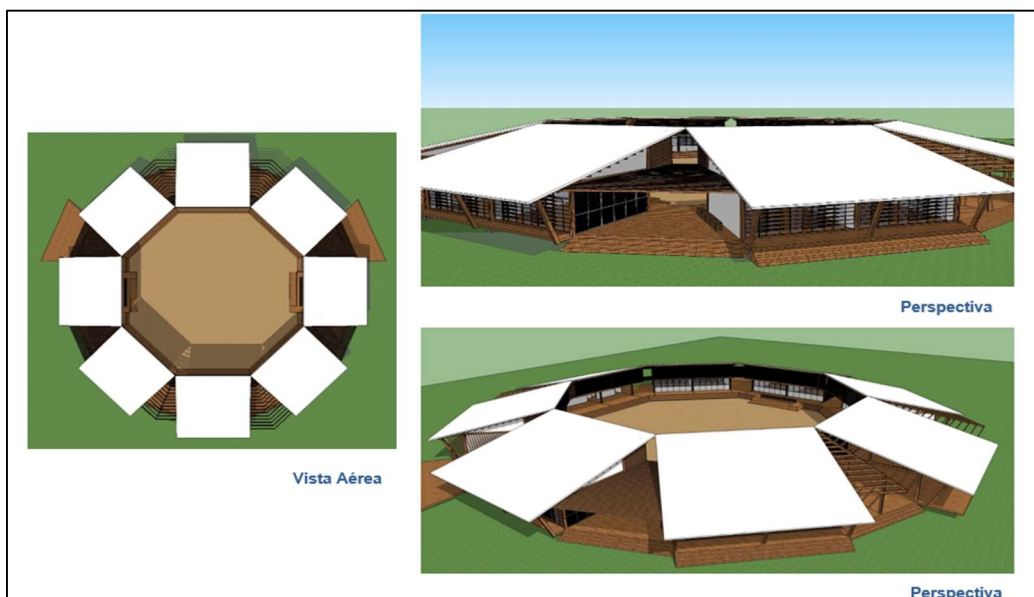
Planta baixa da escola Yanomami – inspirada no Xapono
